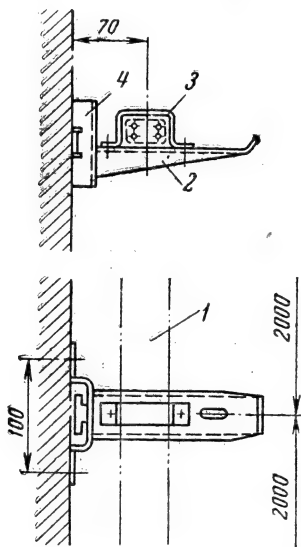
Прокладка шинпровода ШОС67 на стене на кронштейнах.
